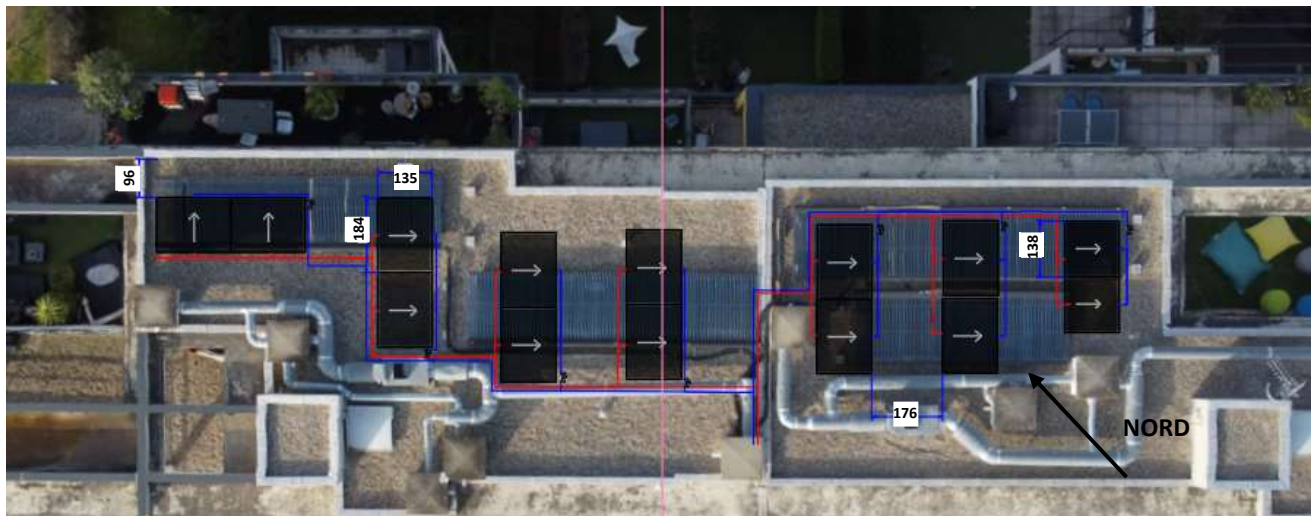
Exemple 2 - Plans de toiture après projet (solaire thermique)
